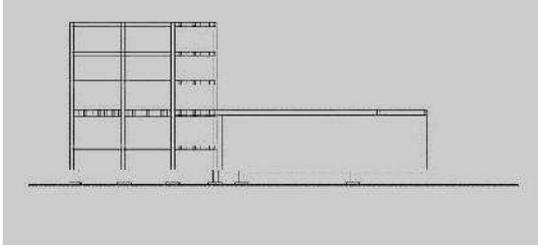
Alzado de sistema constructivo en torre habitacional. Elaborada por Javier García Barrera.
